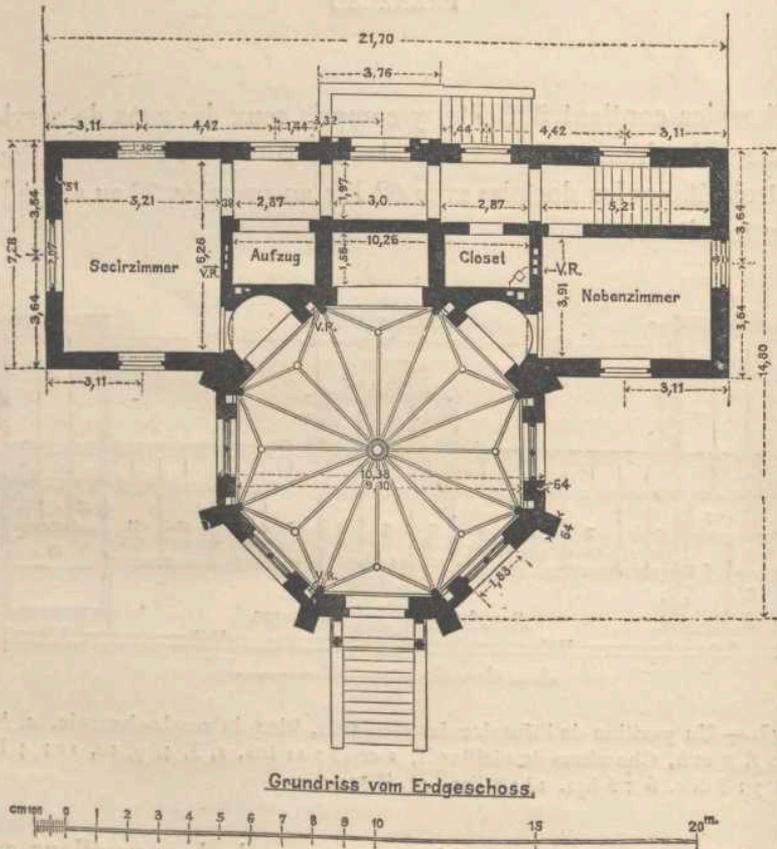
La salle des morts. Plan du rez-de-chaussée. Secirzimmer, salle de dissection. Aufzug, Escalier. Nebenzimmer, Antichambre.
